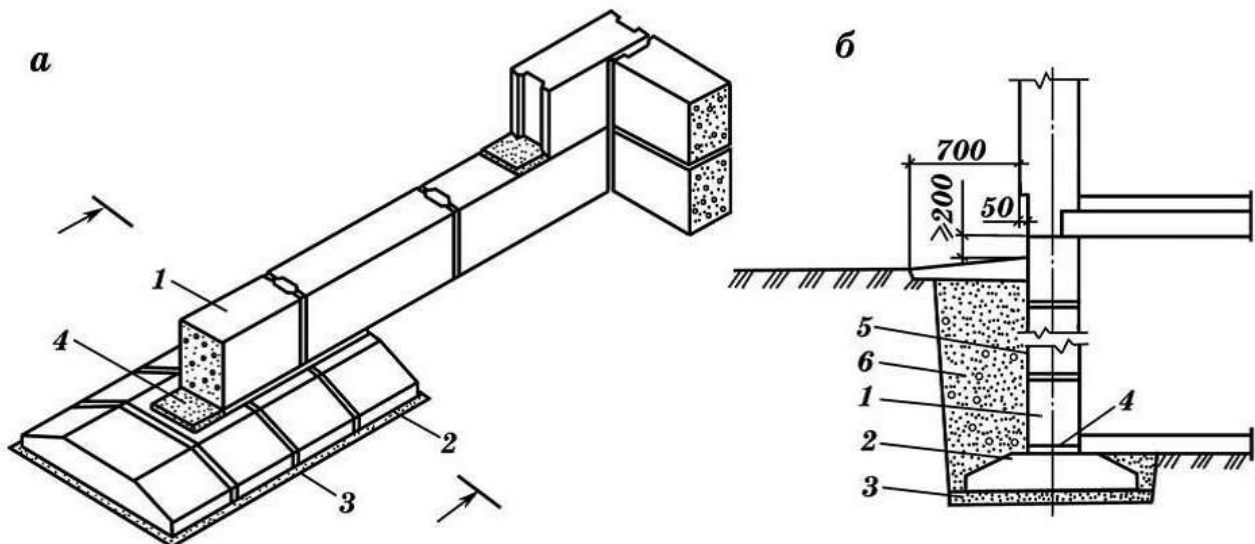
Схема стрічкового фундаменту зі збірних бетонних блоків:
